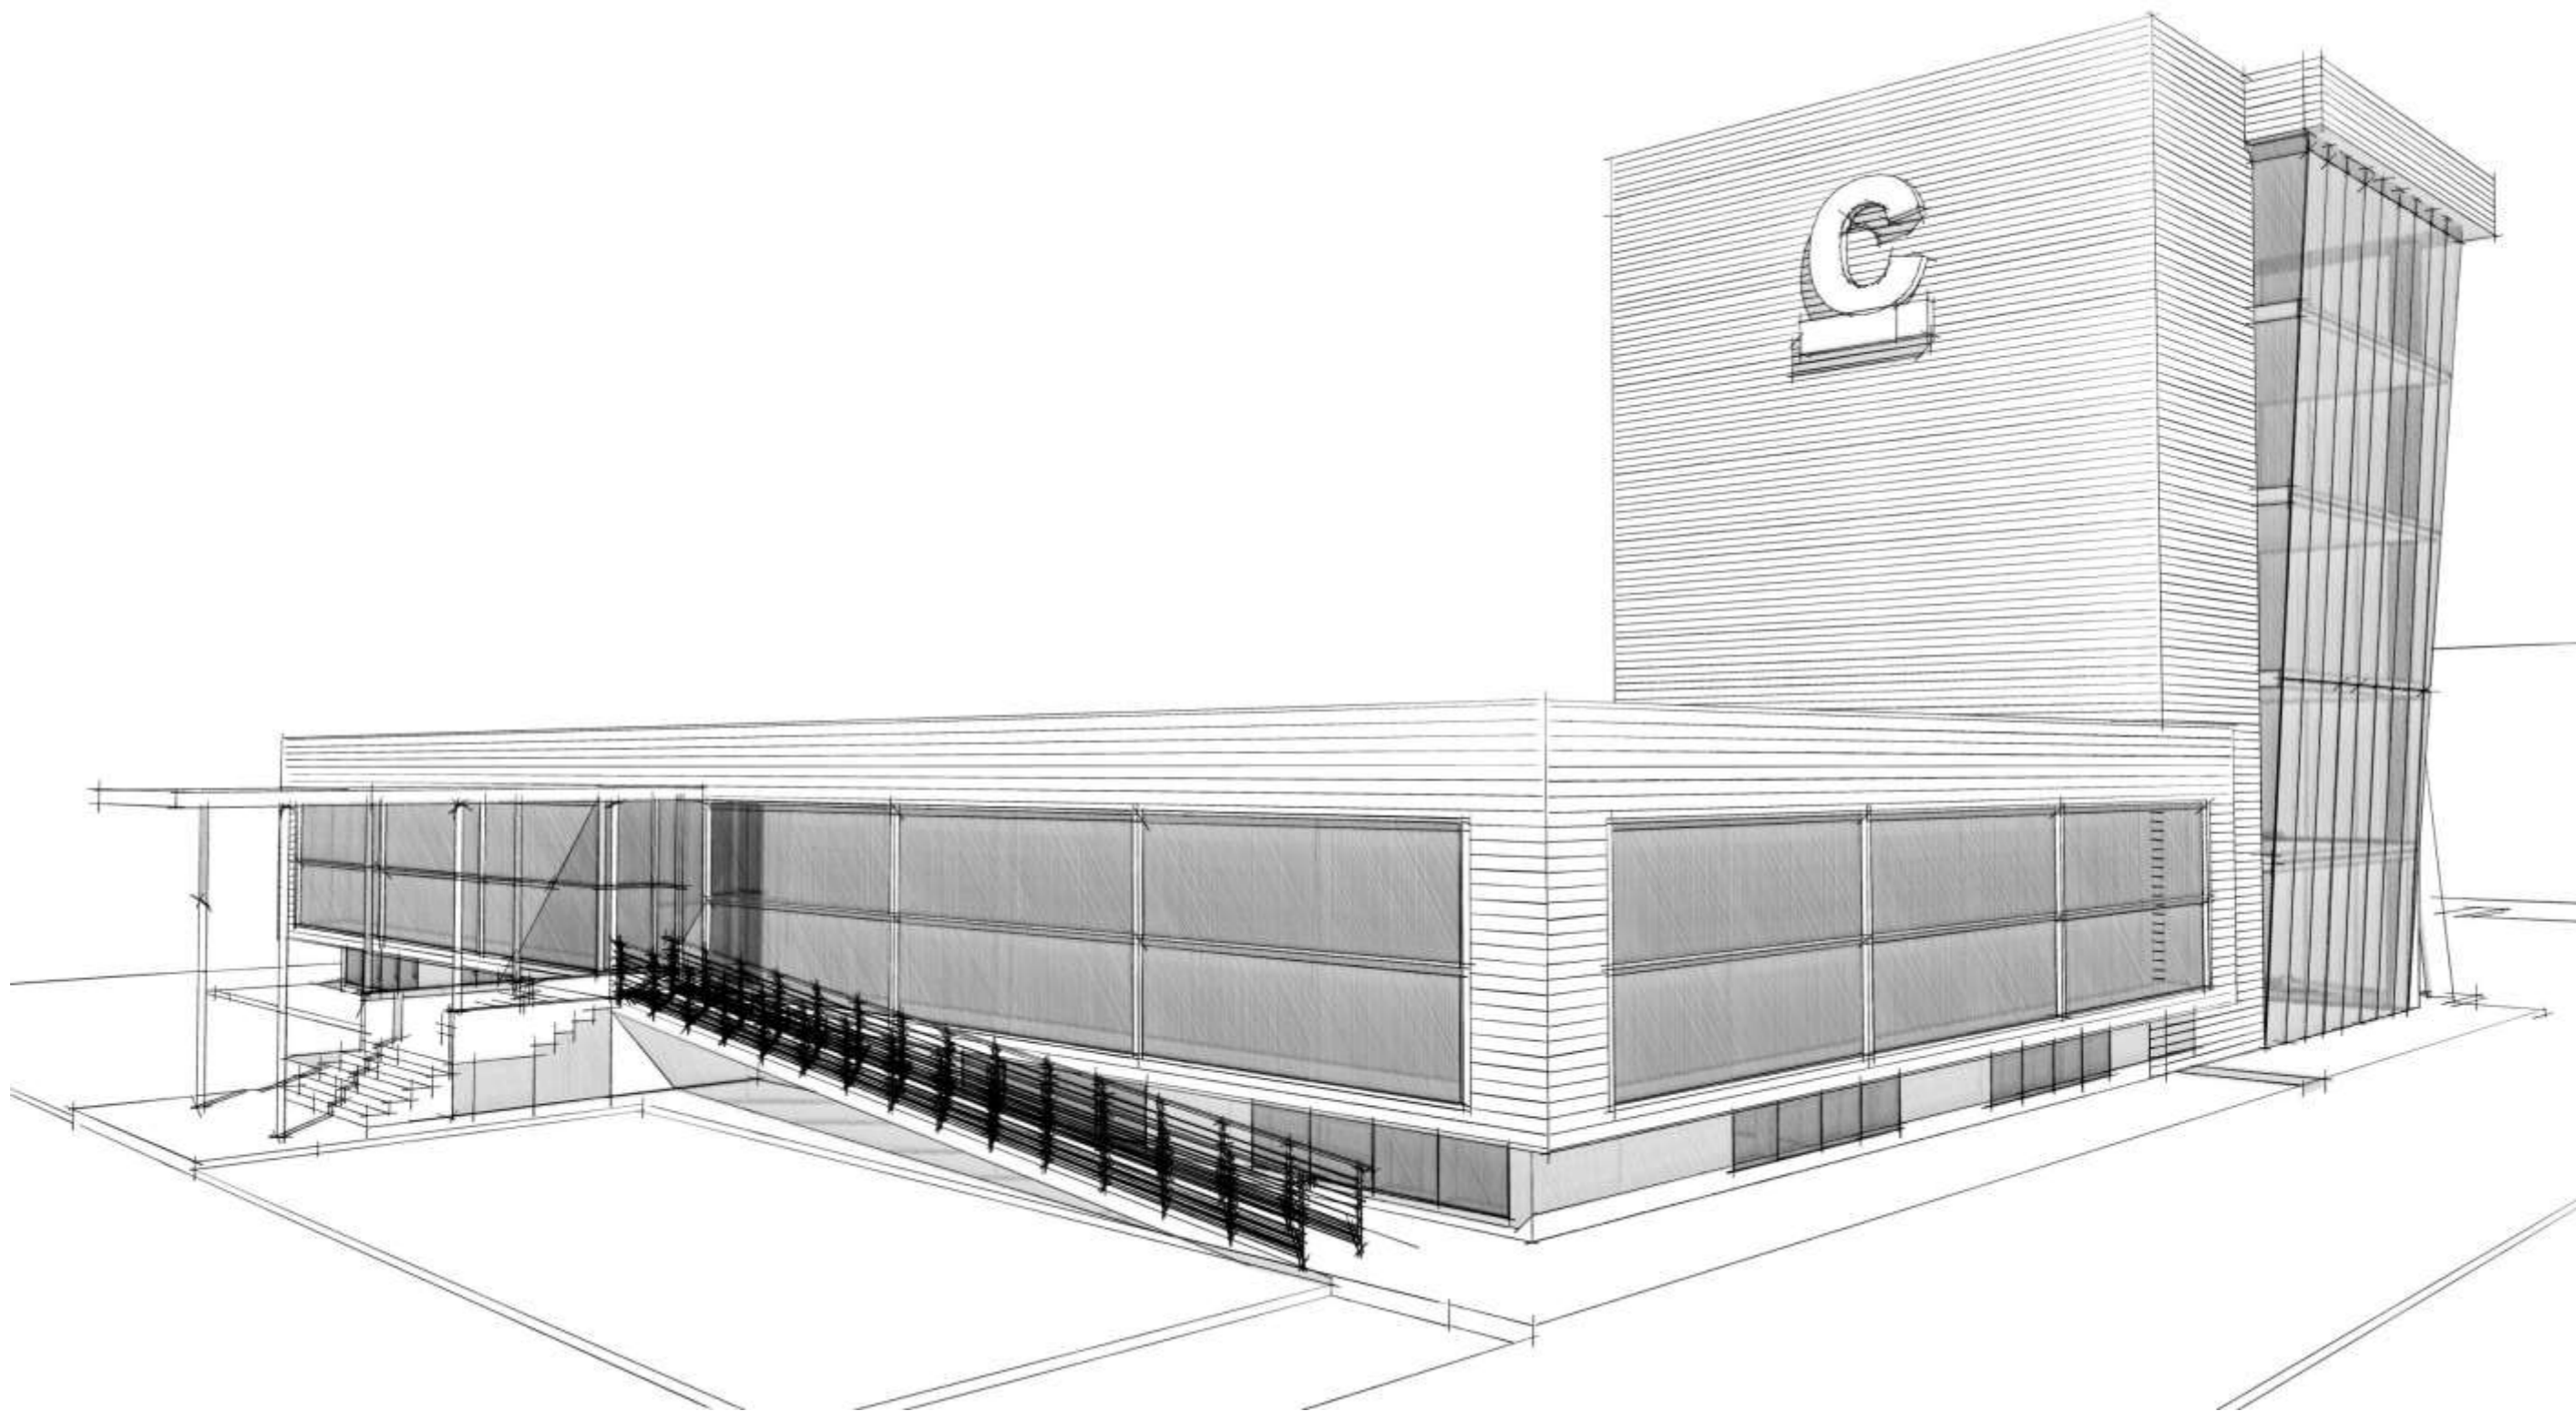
Lato est verso la Zona E 6 con i parcheggi fin sotto l'edificio.-
